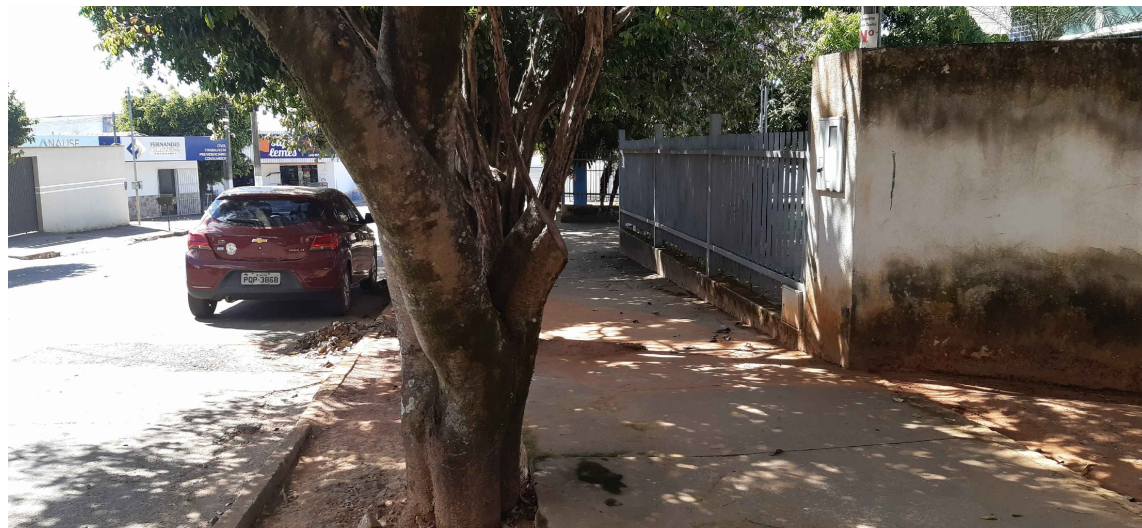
CALÇADA EXISTENTE - DIVISA
